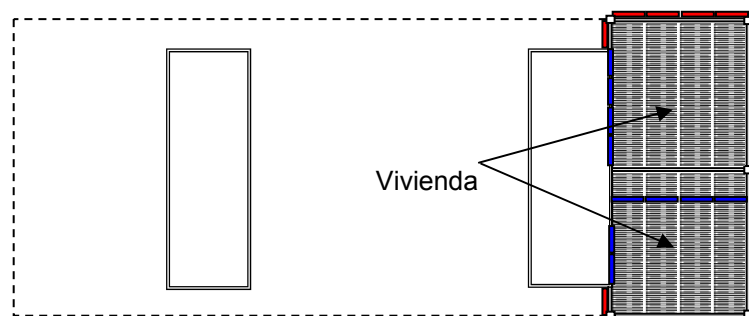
Vista en planta de la zona 3 con los paneles de fachada
